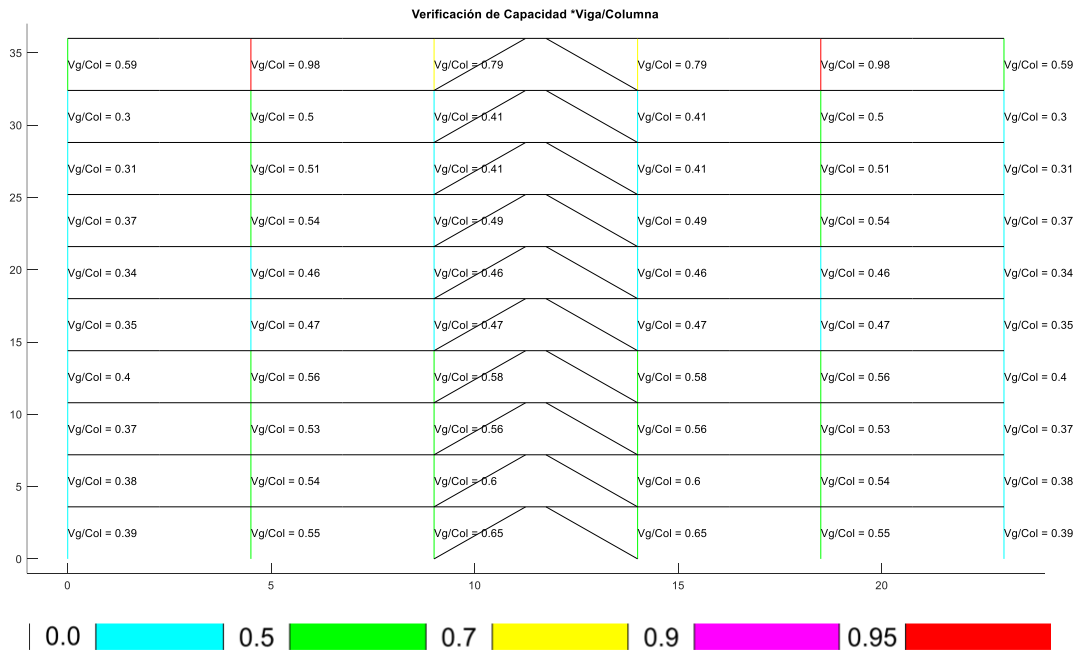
Relaciones columna-fuerte viga-débil, estructura EBF, Ejes 1, 3.
